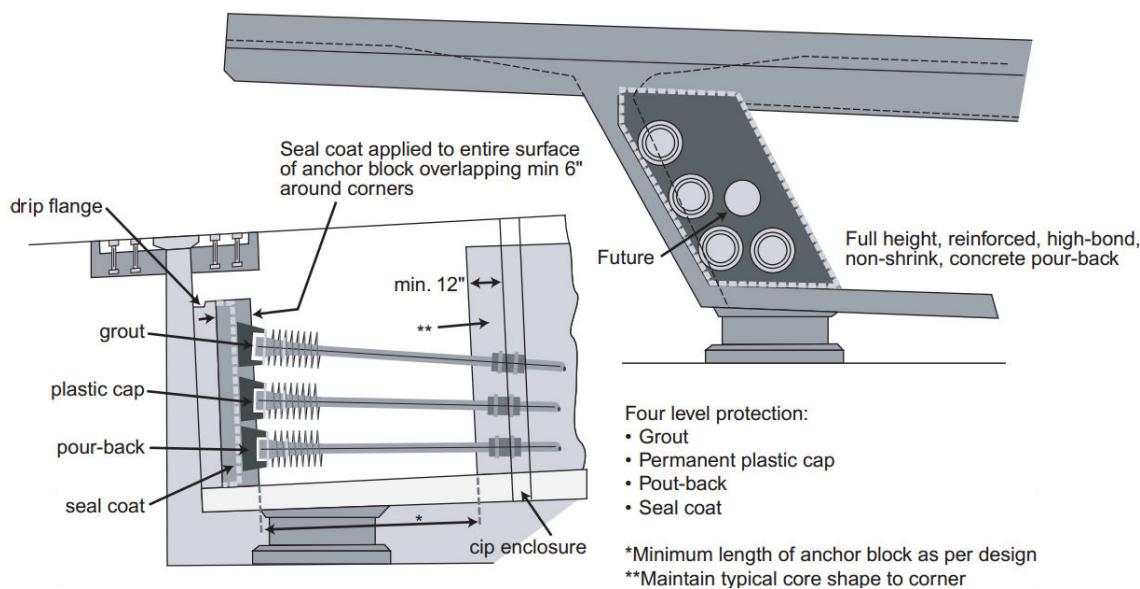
Protección de un grupo de anclajes en un segmento junta de expansión.
